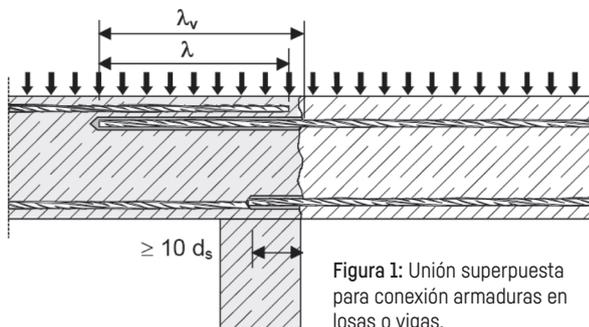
Unión superpuesta para conexión armaduras en losas o vigas.
